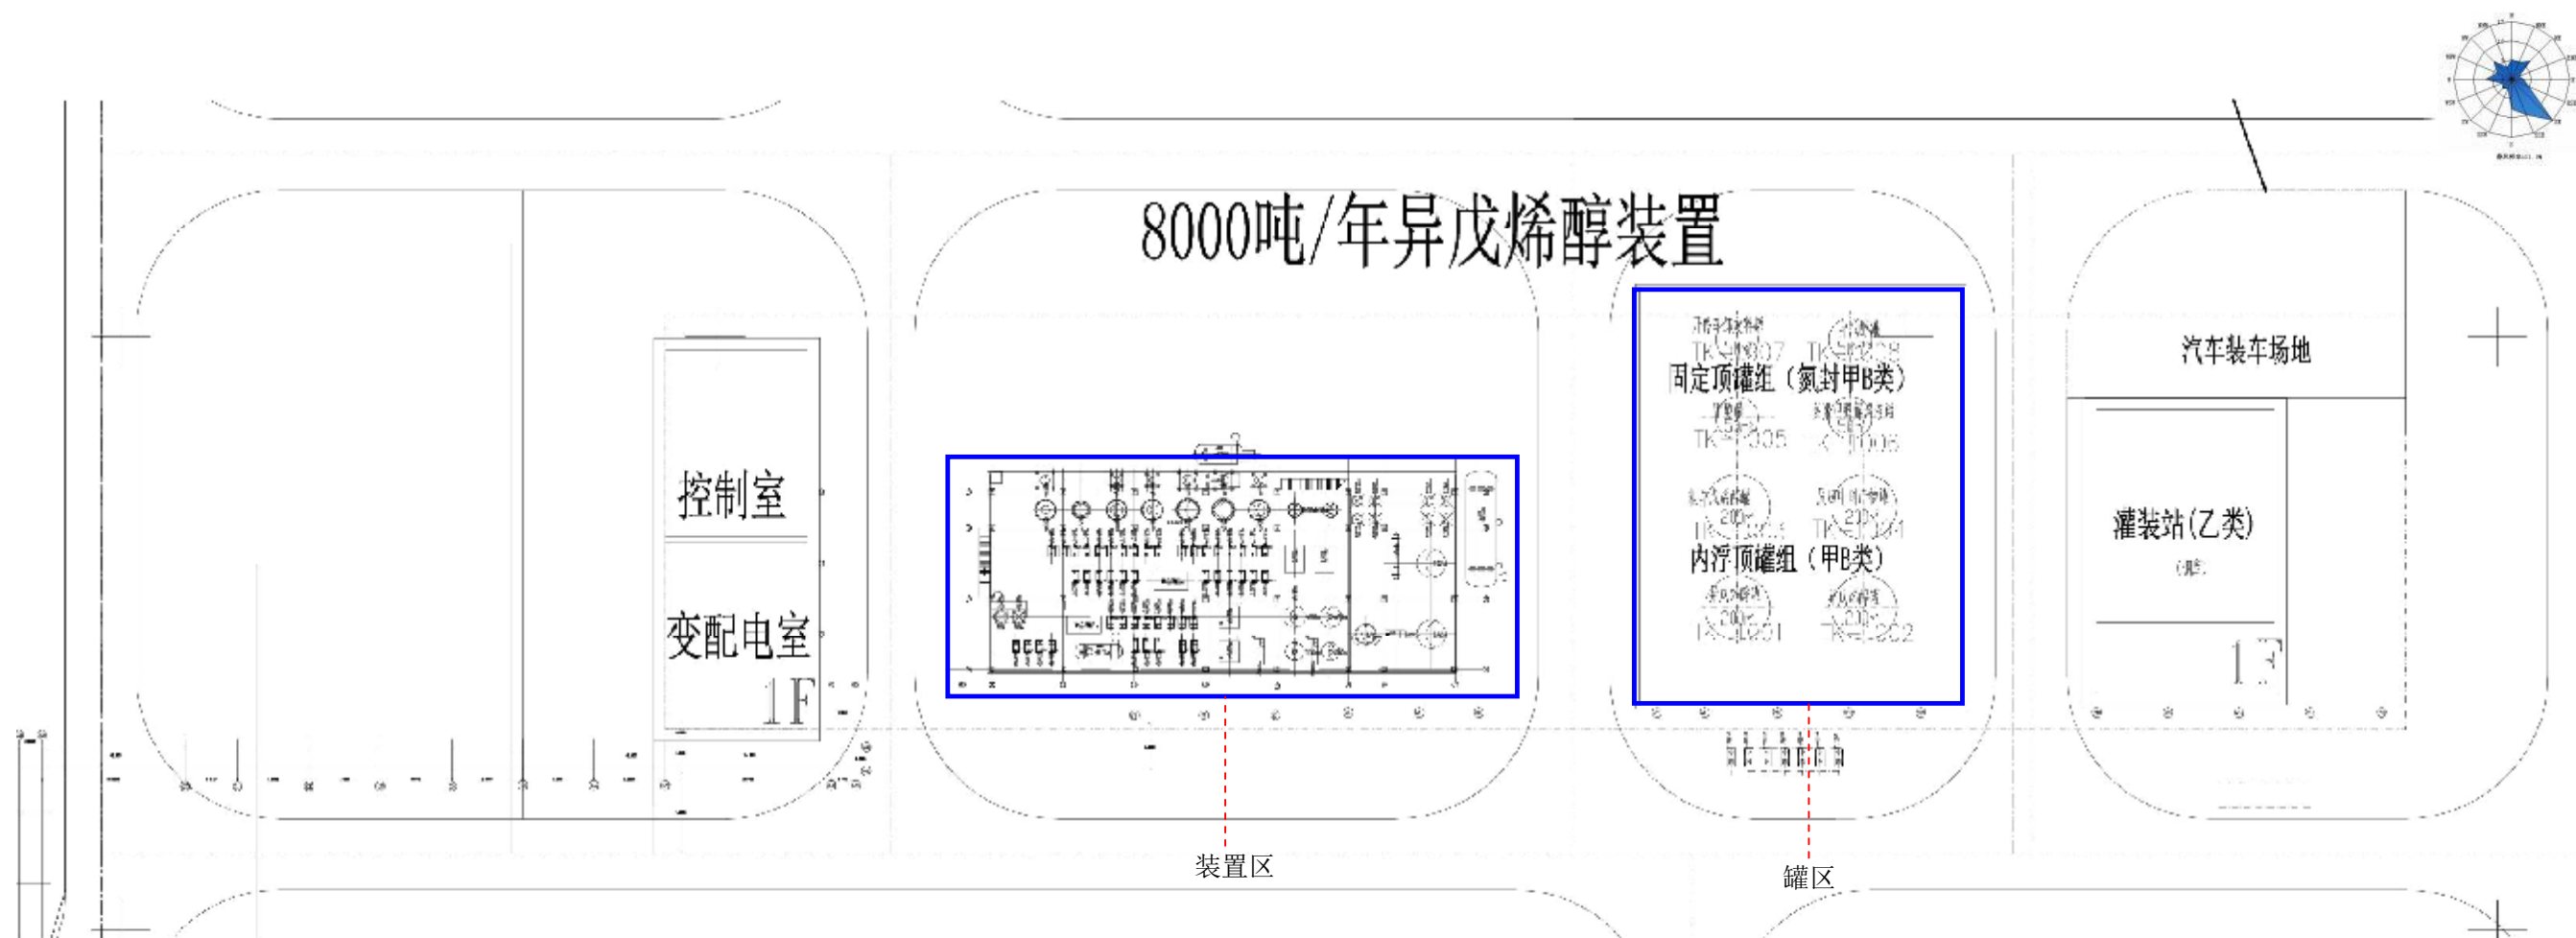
本项目平面布置图 比例尺 1: 1090
